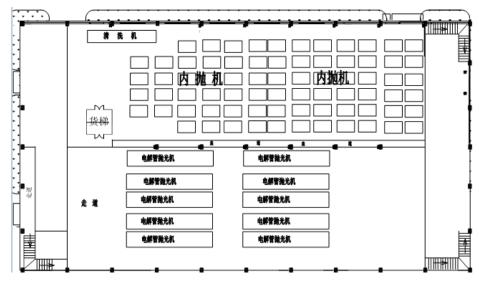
陆丰西路厂区二厂房 2 层设备平面布置图
